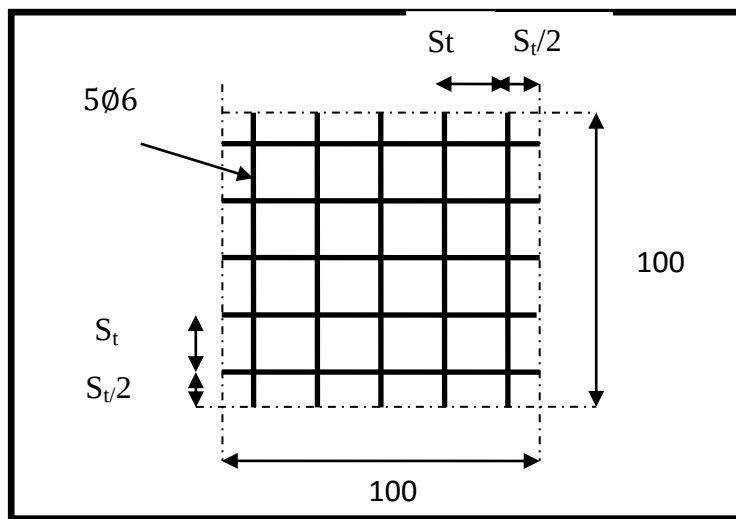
Disposition constructive des armatures de la dalle de compression.
